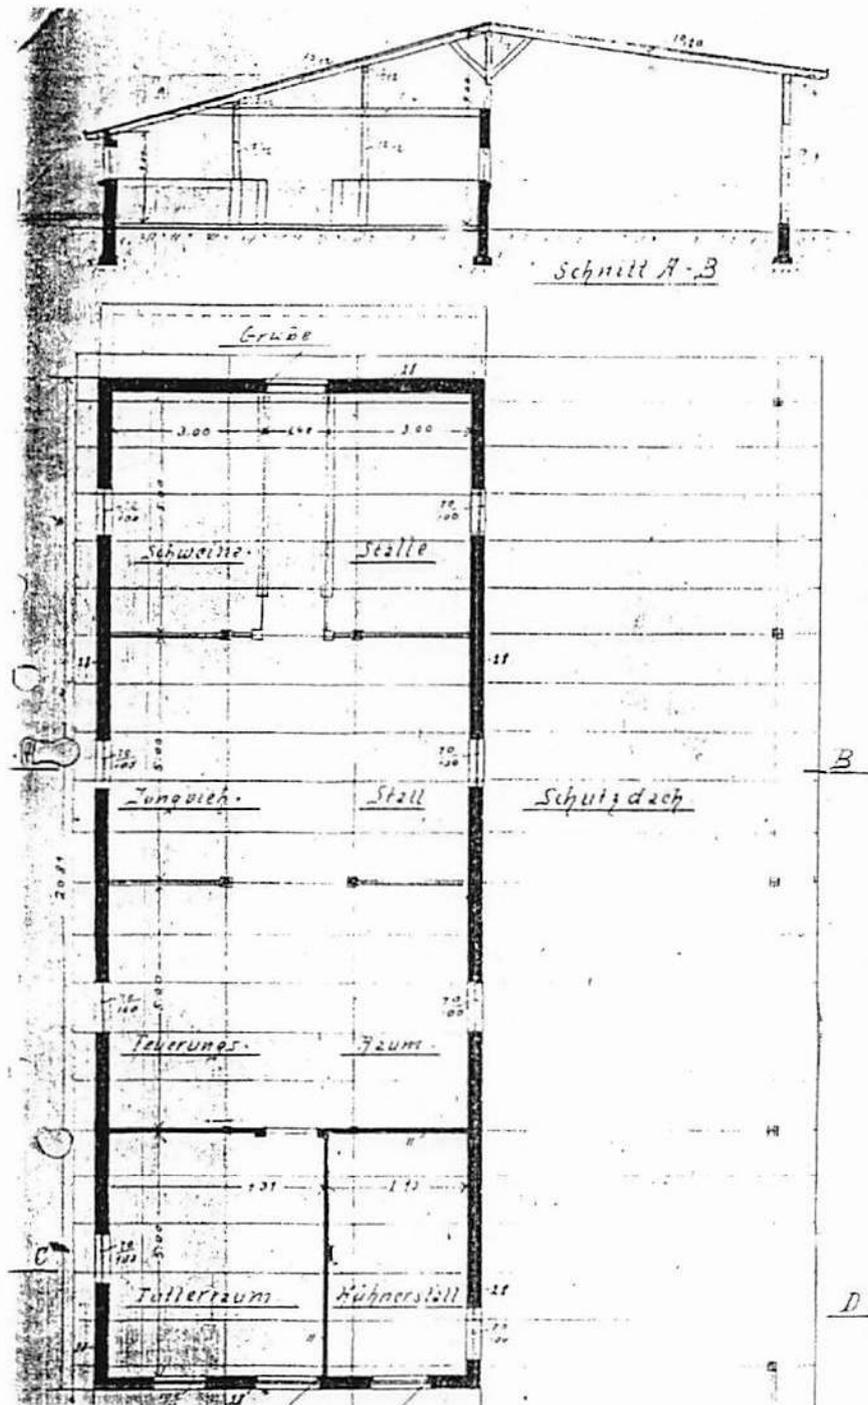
Grundriss / Schnitt Nebengebäude Stall
